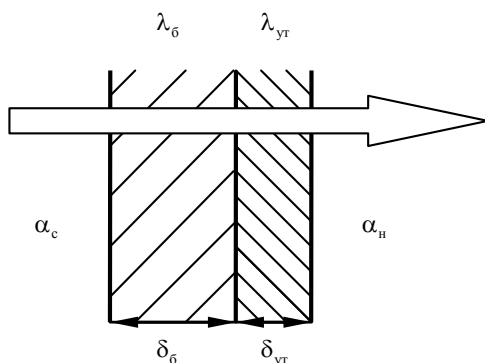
Схема теплообмена фрагмента боковой стенки, расположенного выше уровня грунта
